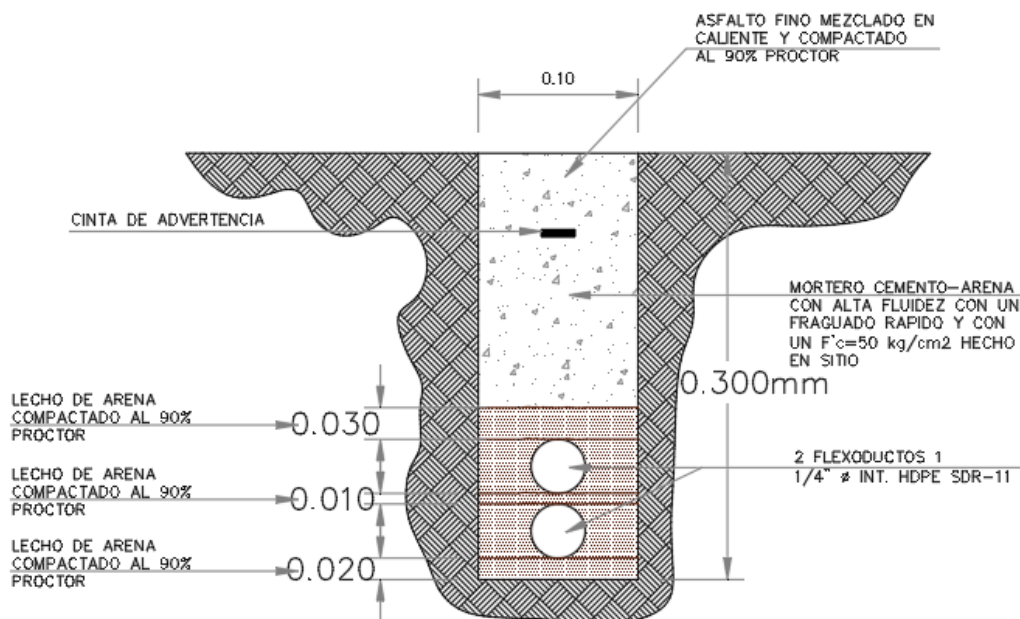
DETALLE DE CEPA PARA INSTALACIÓN SUBTERRÁNEA.
